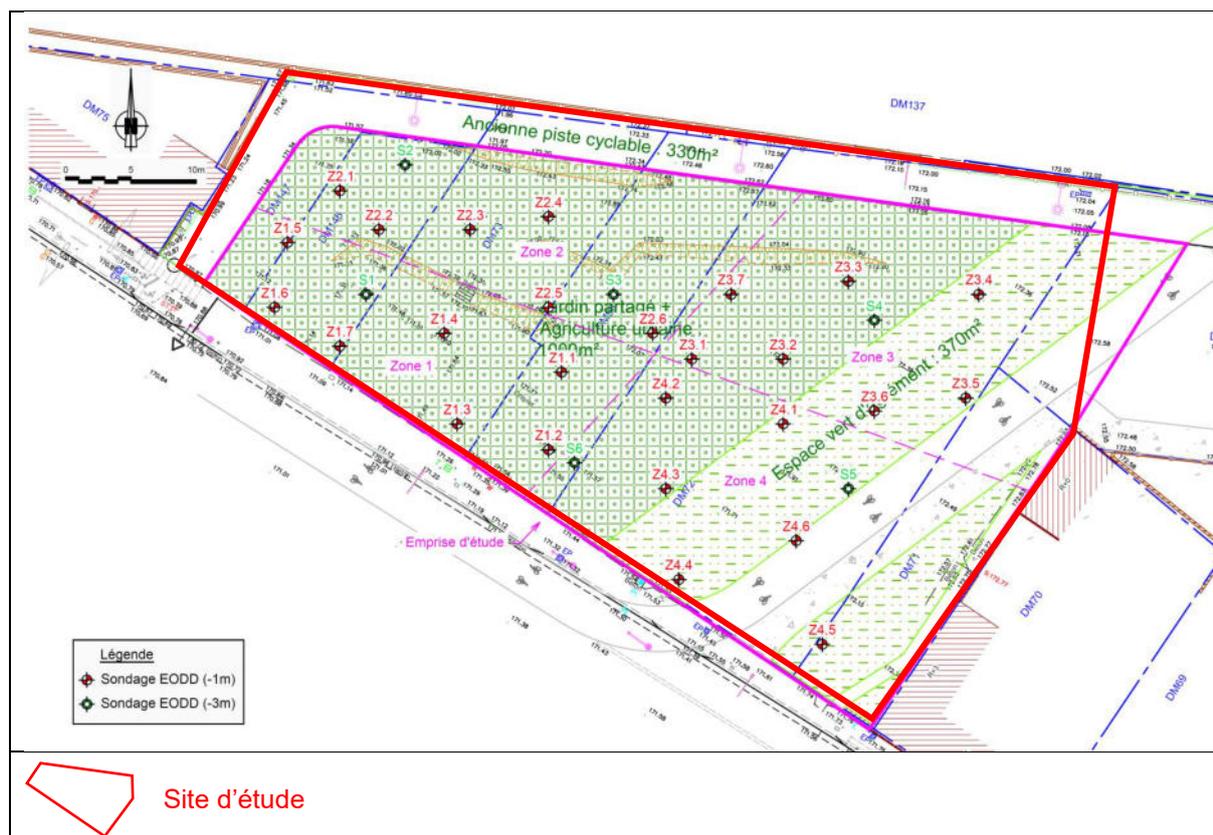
Plan d'aménagement du jardin (Source : Ville de Lyon)
